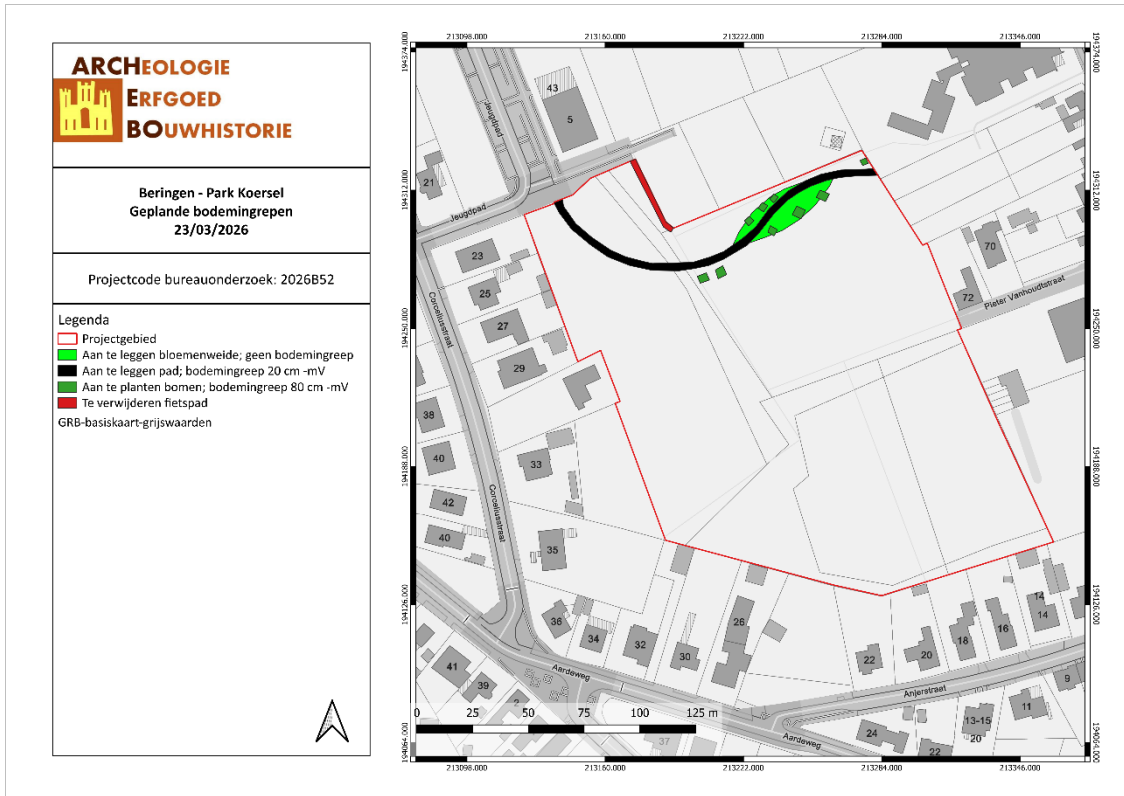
Inplantingsplan geplande toestand (opdrachtgever, 2026)
